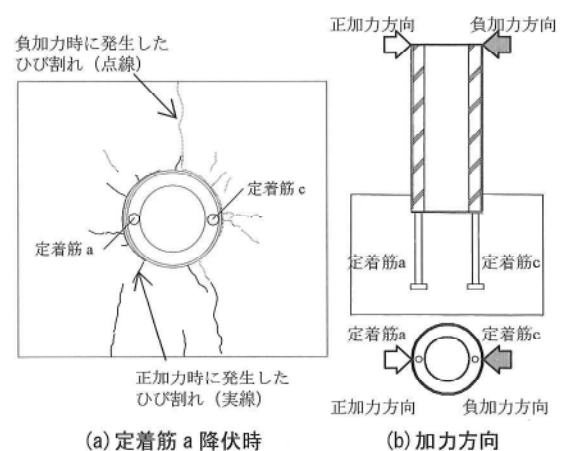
パイルキャップ表面のひび割れの例 (試験体 No.1)
